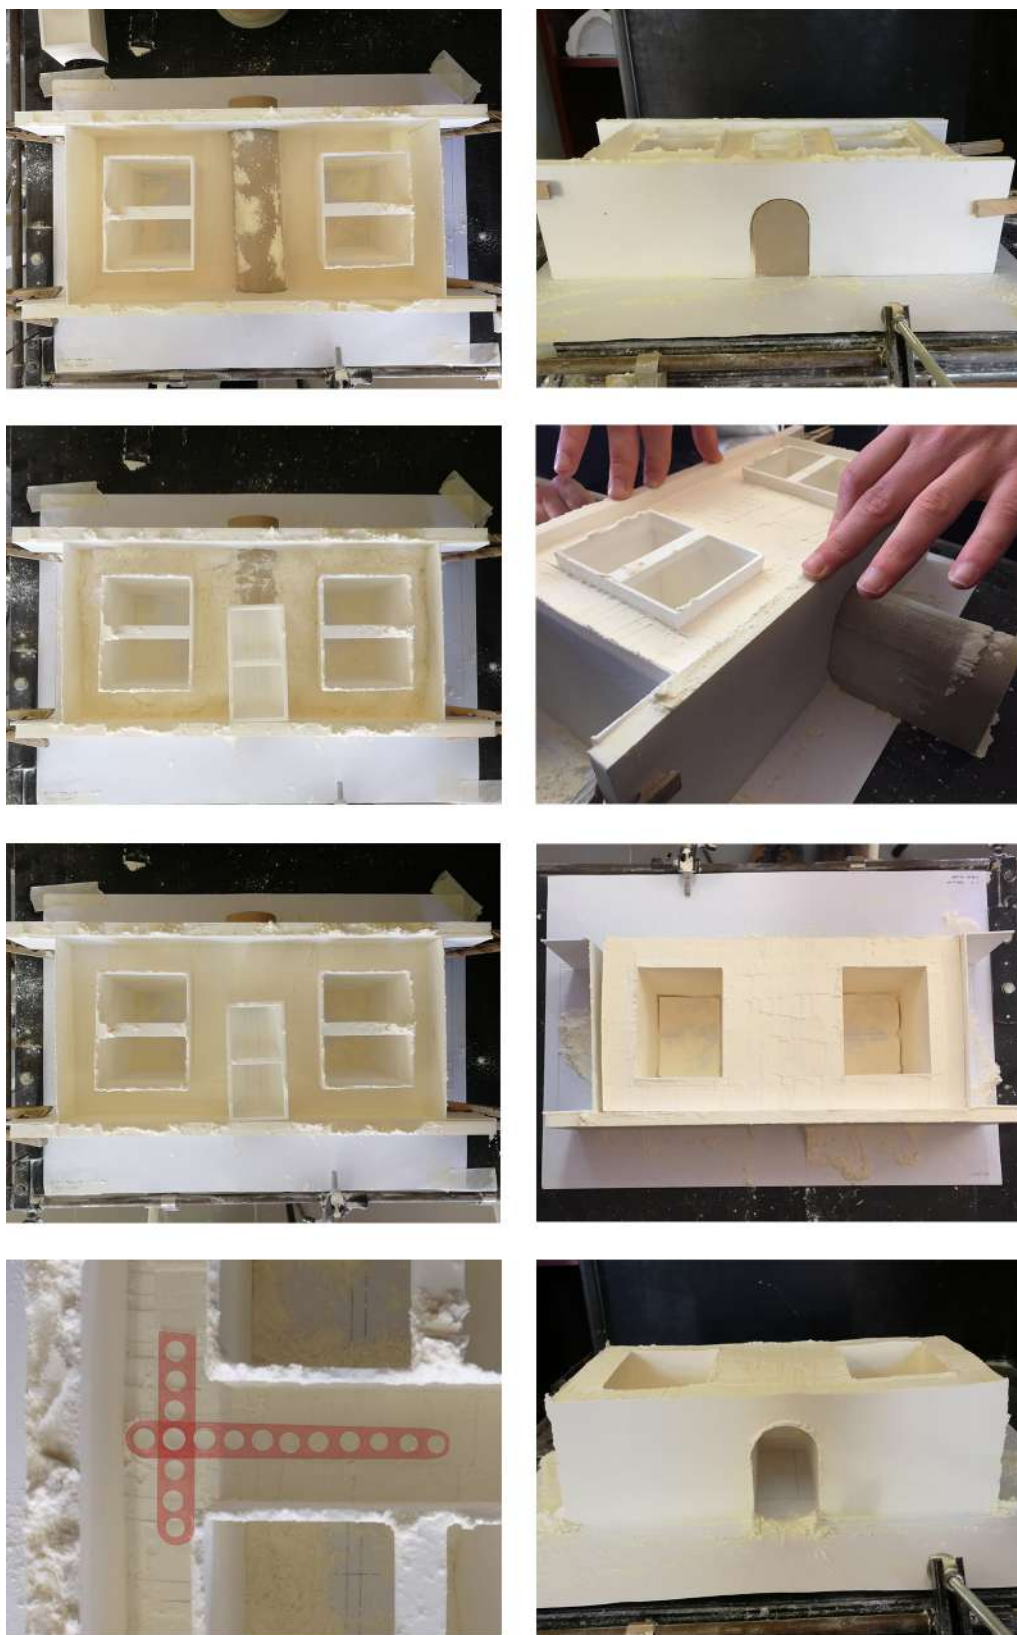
Costruzione di elementi di collegamento (archi e volte in farina) ed incatenamenti (bacchette di caffè nello spessore murario) nelle prove di laboratorio: fasi di montaggio e disarmo (G. Ajò, foto 2018-2019).
